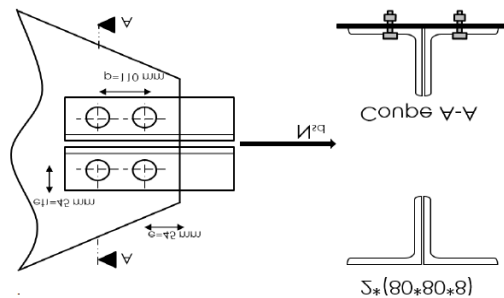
Détail des dispositions des boulons de la poutre au vent.
